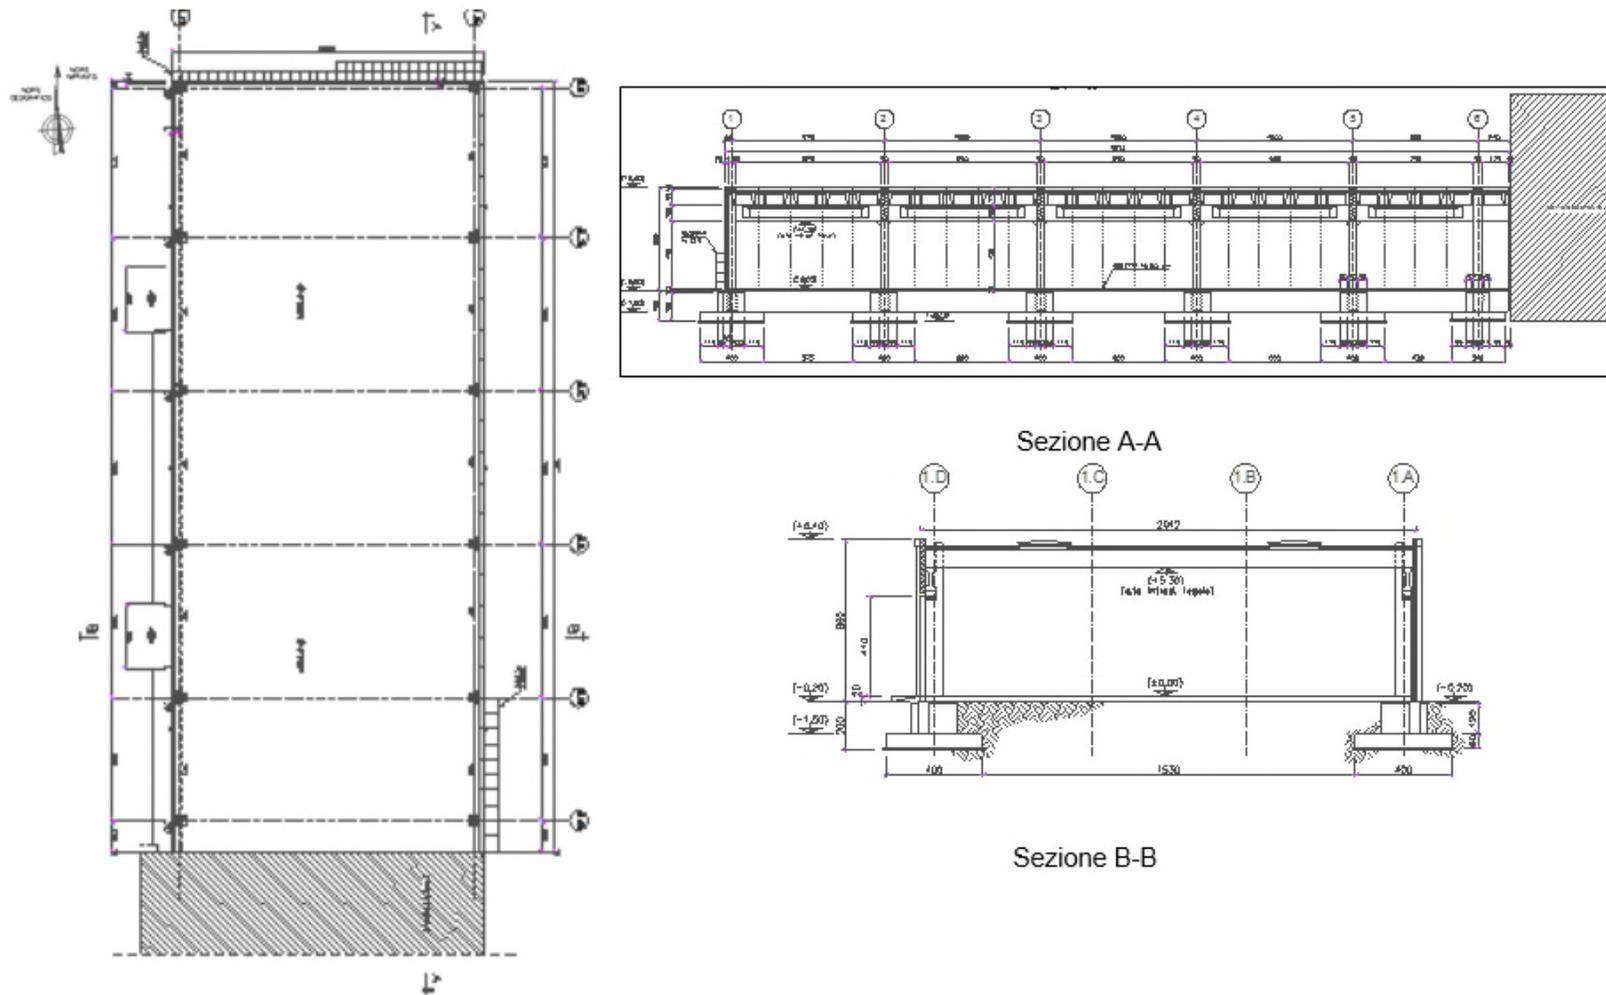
Pianta, sezione longitudinale e sezione trasversale D1 *ante-operam
